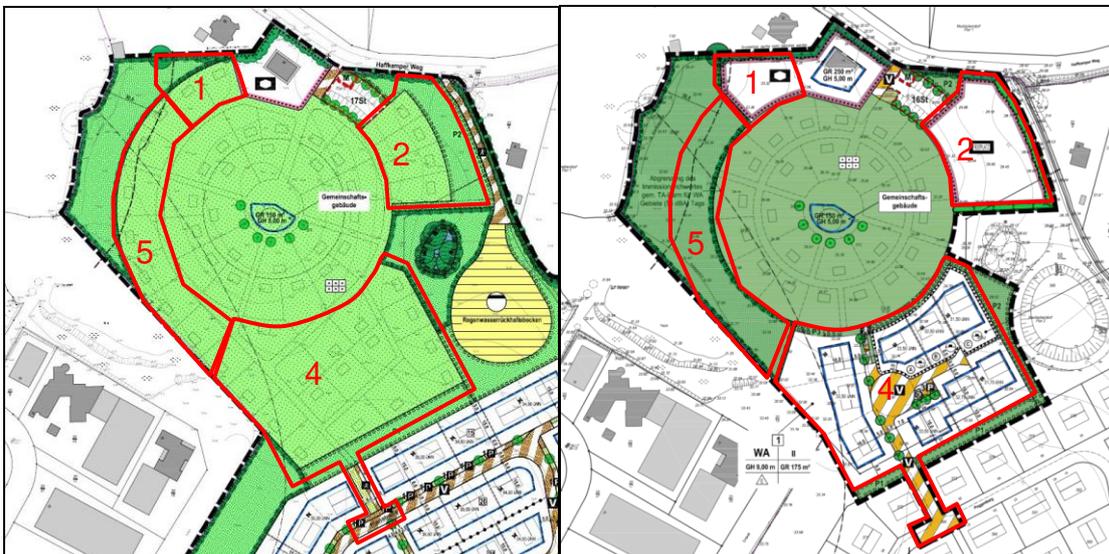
Lage der geplanten Änderungen im Vergleich alt – neu (Guntram Blank, Architekturbüro für Stadtplanung)
